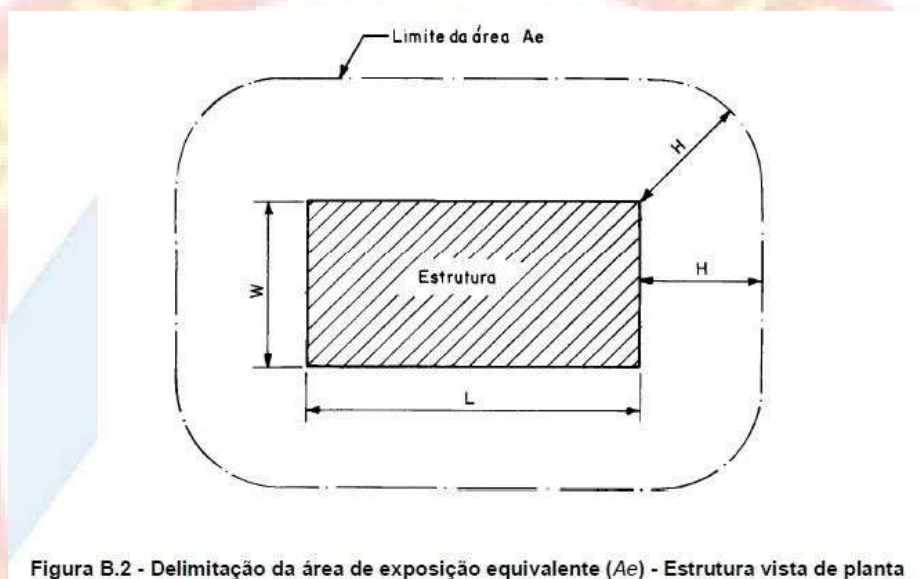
Delimitação da área de exposição equivalente (A_e) - Estrutura vista de planta
